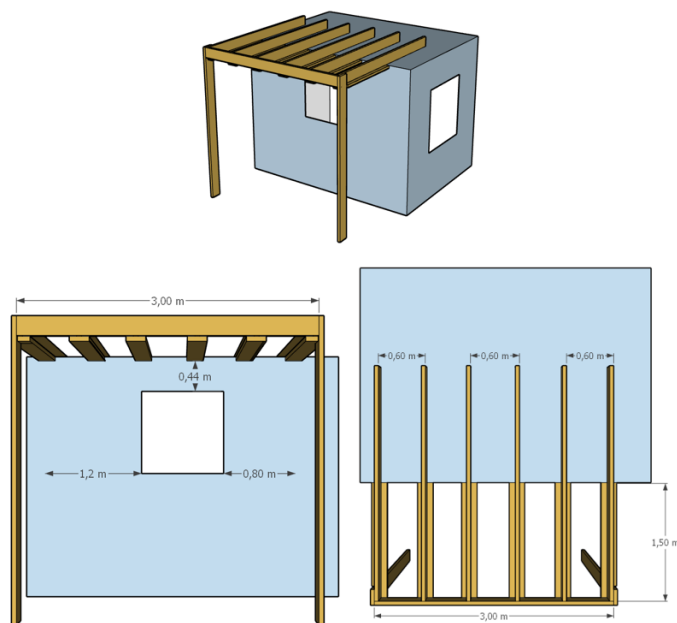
Konstruksjonen ferdigstilt til testbrann
